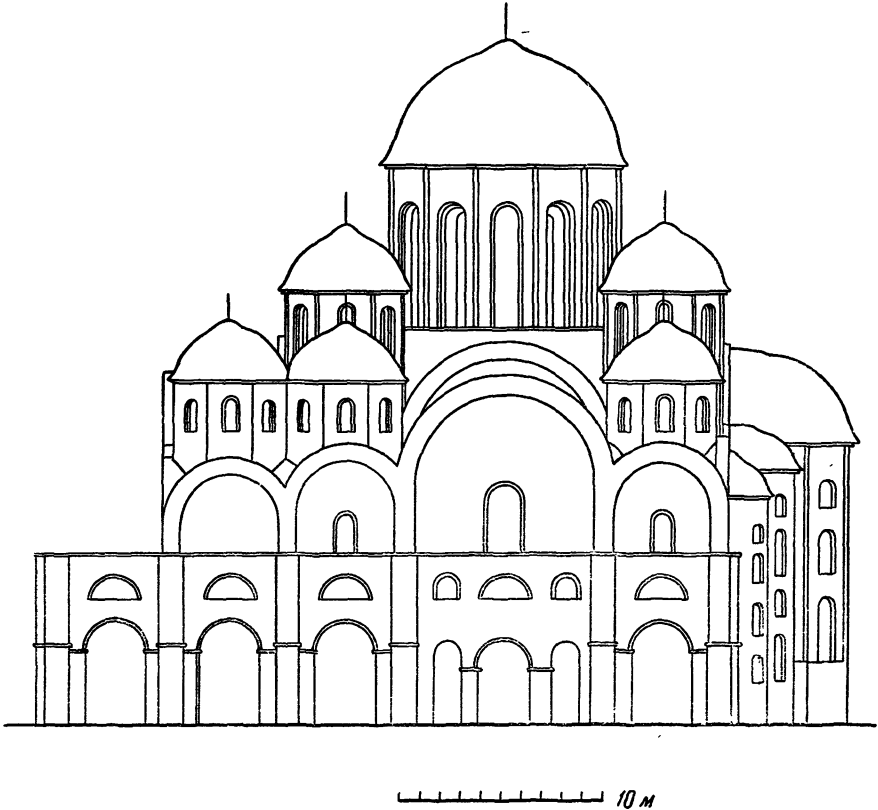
Схема реконструкции южного фасада Софии в Киеве
